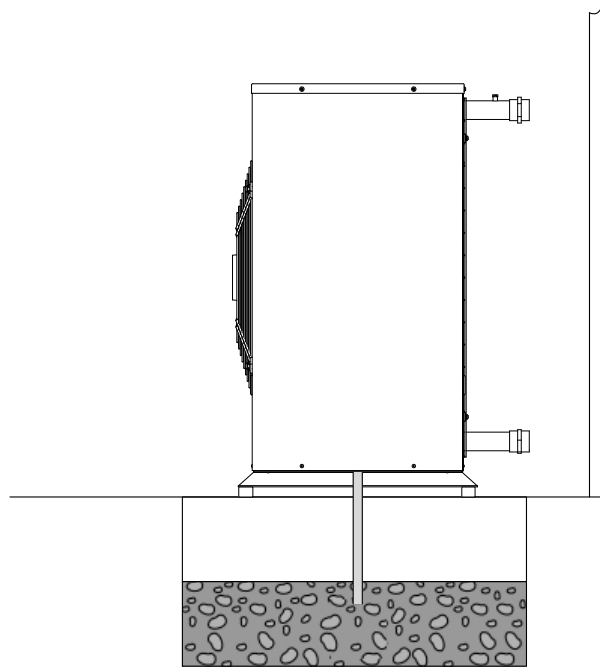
Support avec raccordement du bac à la couche de gravier utilisée pour le drainage de l'eau
